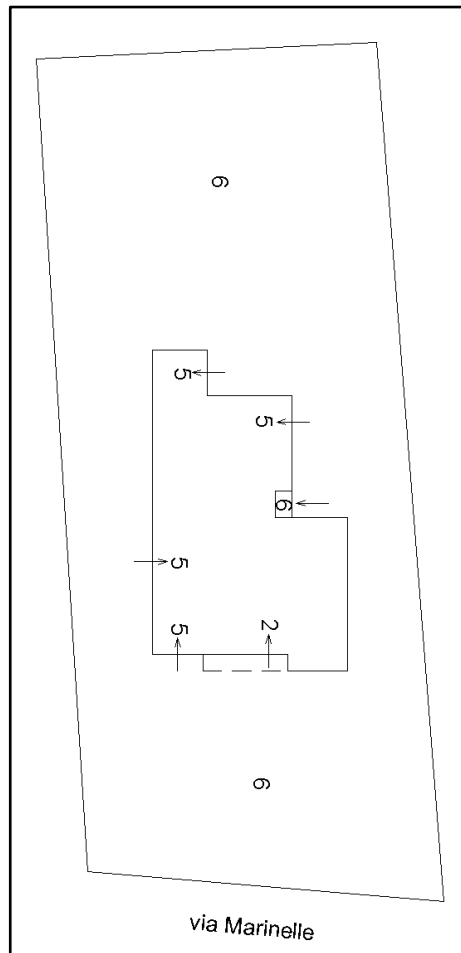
Estratto dell'elaborato planimetrico, piano terra (dimostrazione grafica subaltemi)
